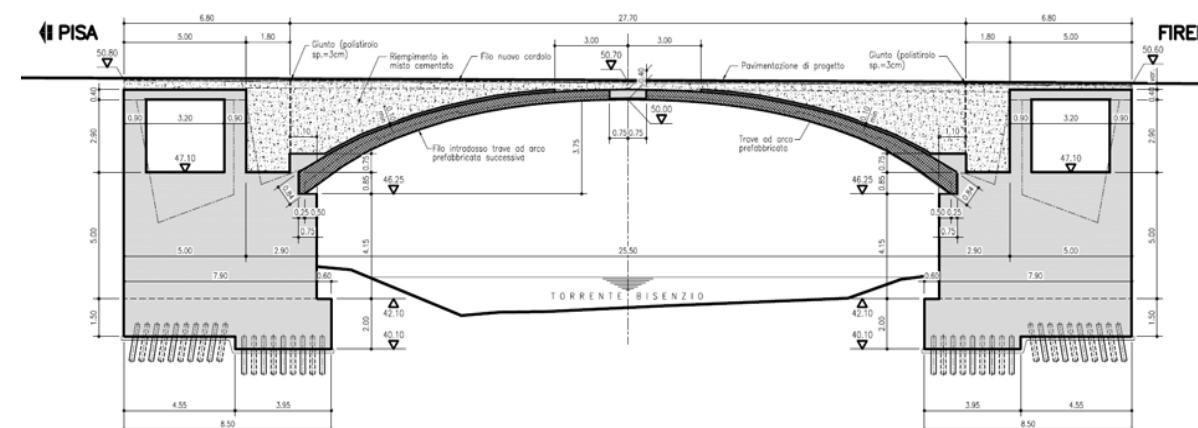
Sezione longitudinale dell'allargamento, lato nord
